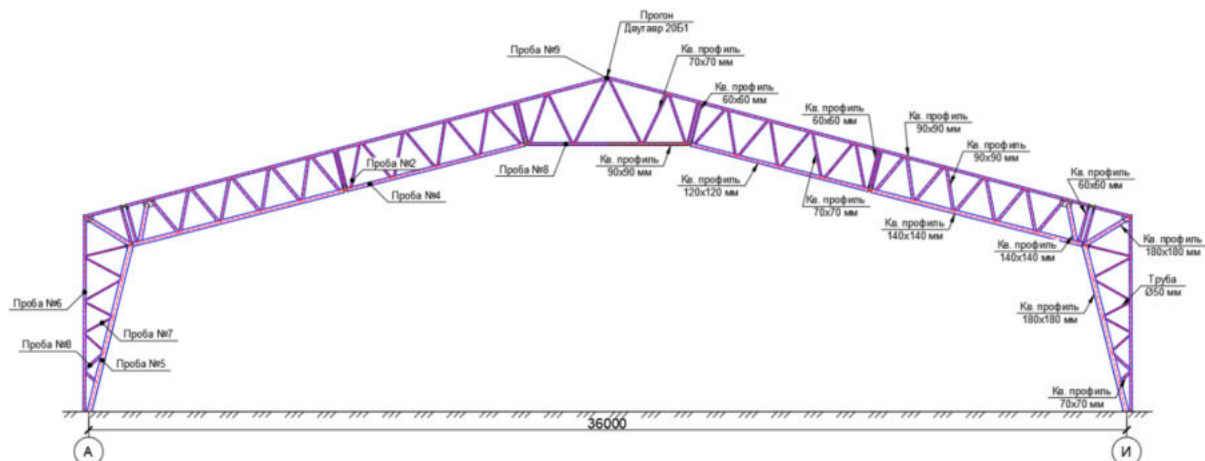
Схемы расположения мест отбора проб металла с несущих конструкций рам каркаса.
